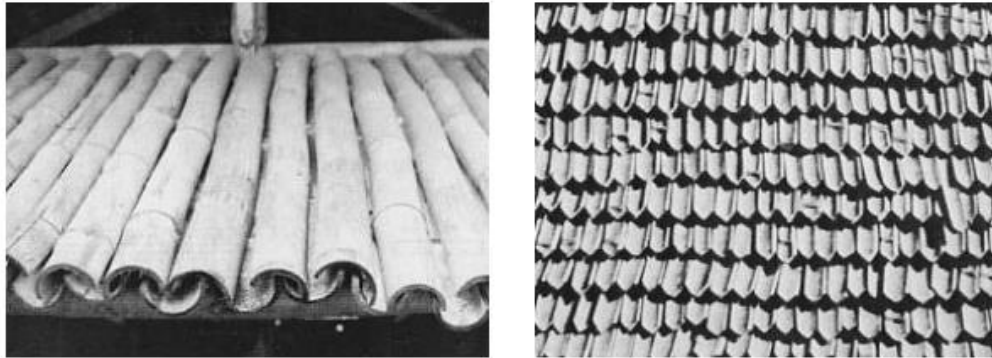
a) Telhado em meias canas de bambu; b) Telhado com telha em lanceta (Correia 2014).
